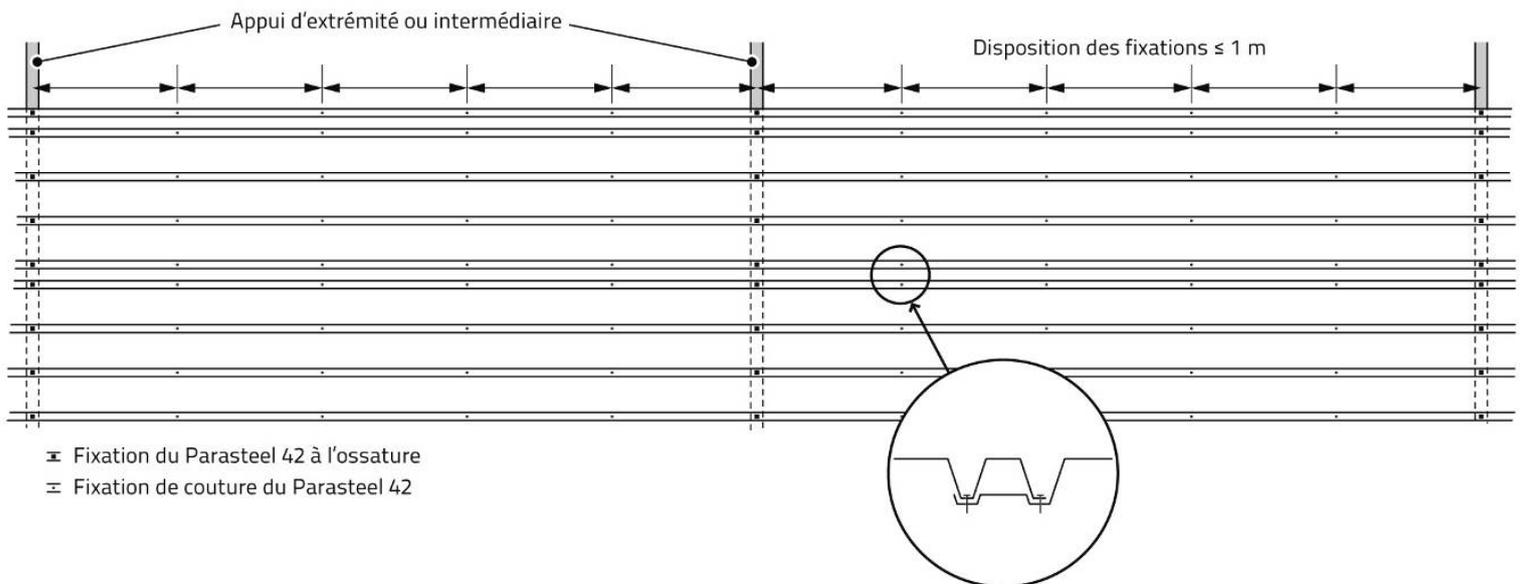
Dispositions des fixations de couture du bac et des fixations de ce bac à l'ossature
